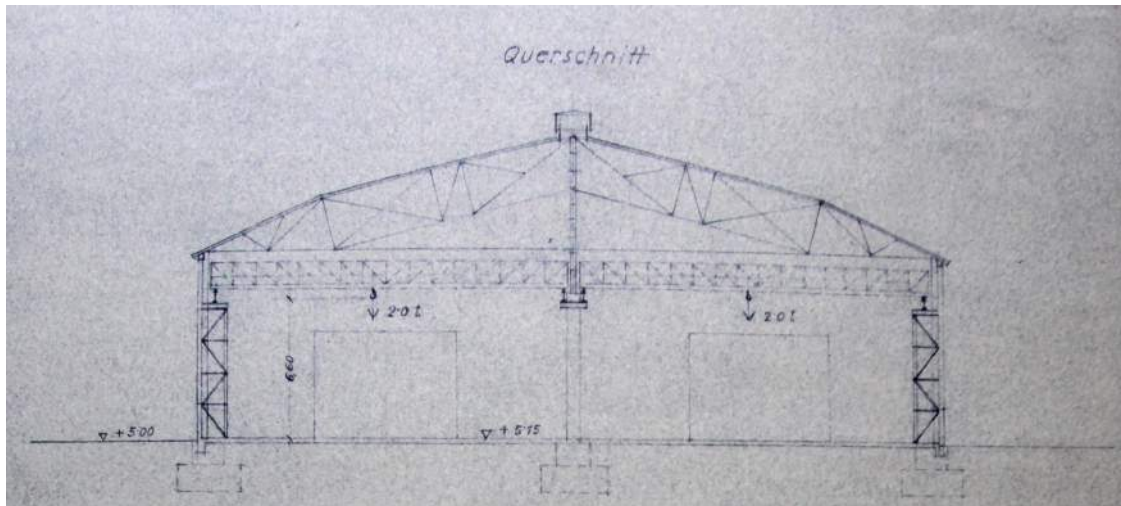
Querschnitt mit verstärkter Stahlkonstruktion und Laufkränen
